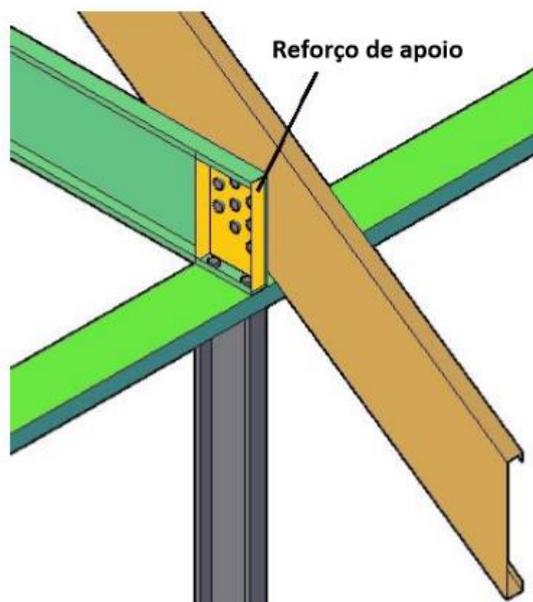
Pormenor de ligação entre vigas no beirado, com reforço de apoio (Silvestre et al, 2013)
